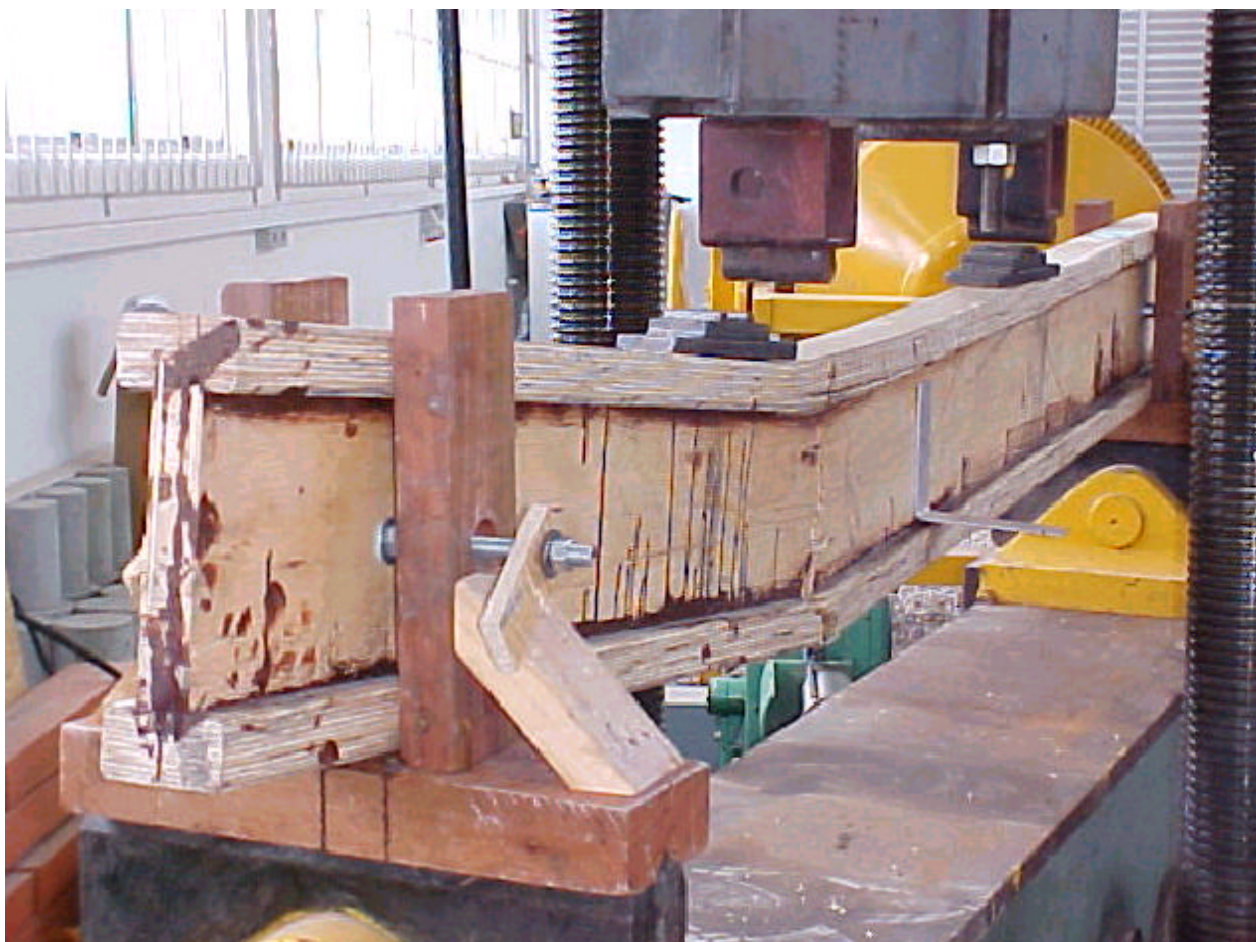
Ruptura da Viga Mesa LVL – V2 – Flexão e Tração da Mesa inferior
